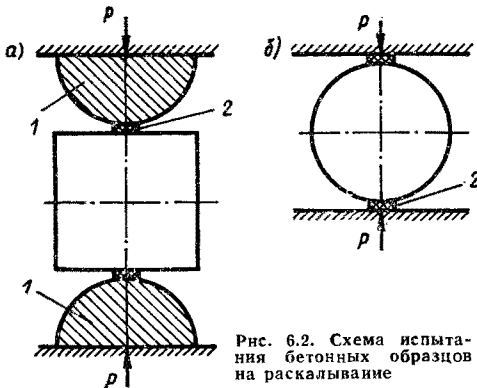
Схема испытания бетонных образцов на раскалывание
